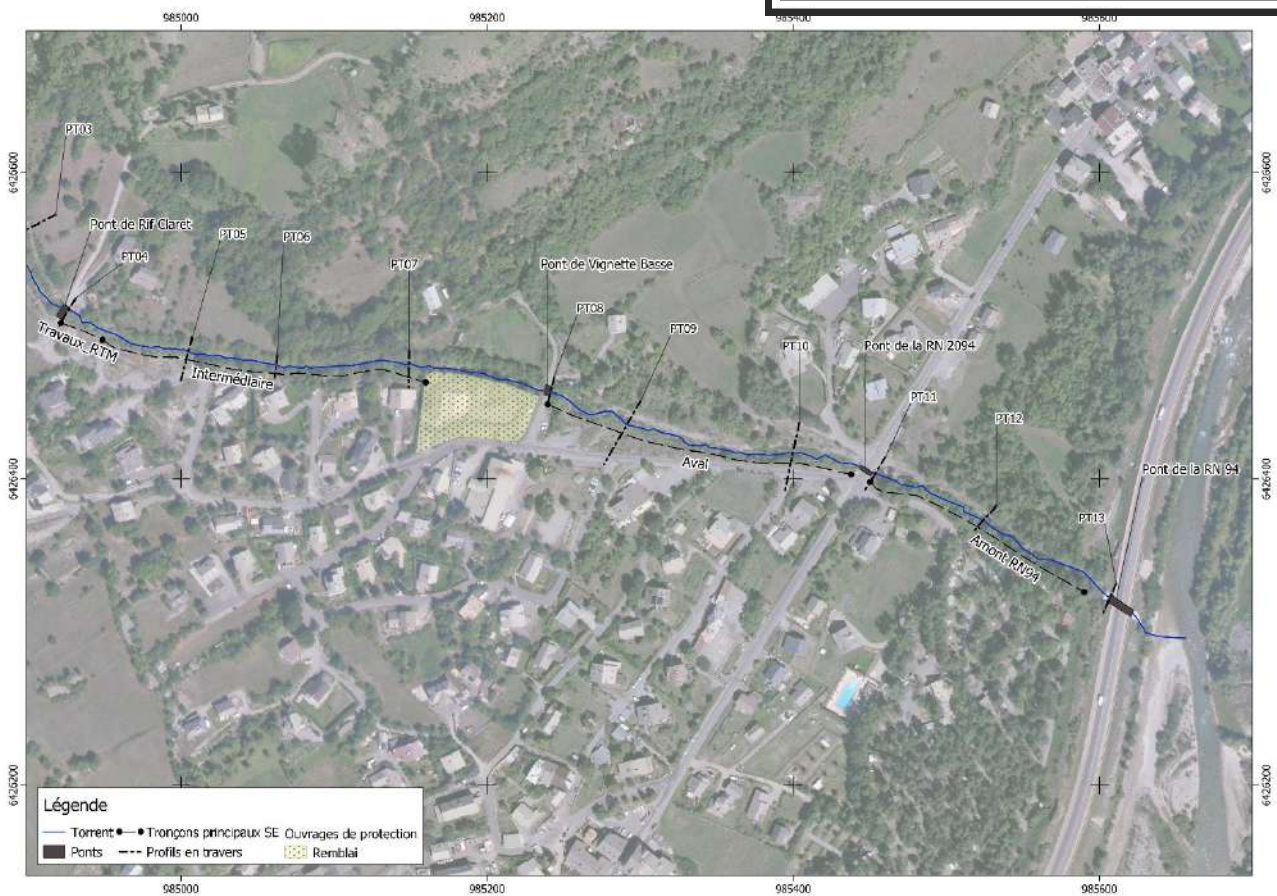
Plan d'ensemble constituant le système d'endiguement
